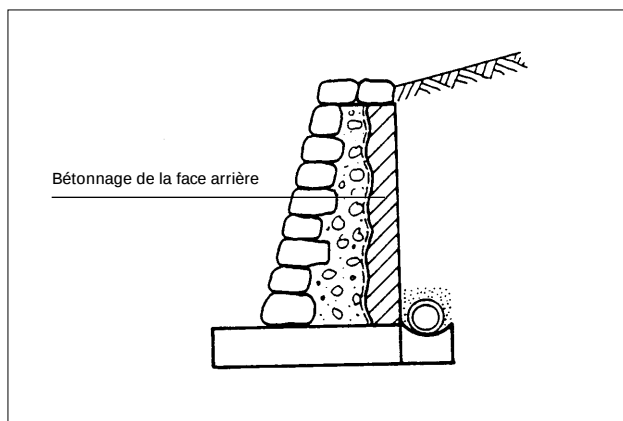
Assainissement d'un mur constamment détrempé: mise à jour de la face arrière, pose d'un drainage, bétonnage de la face arrière
